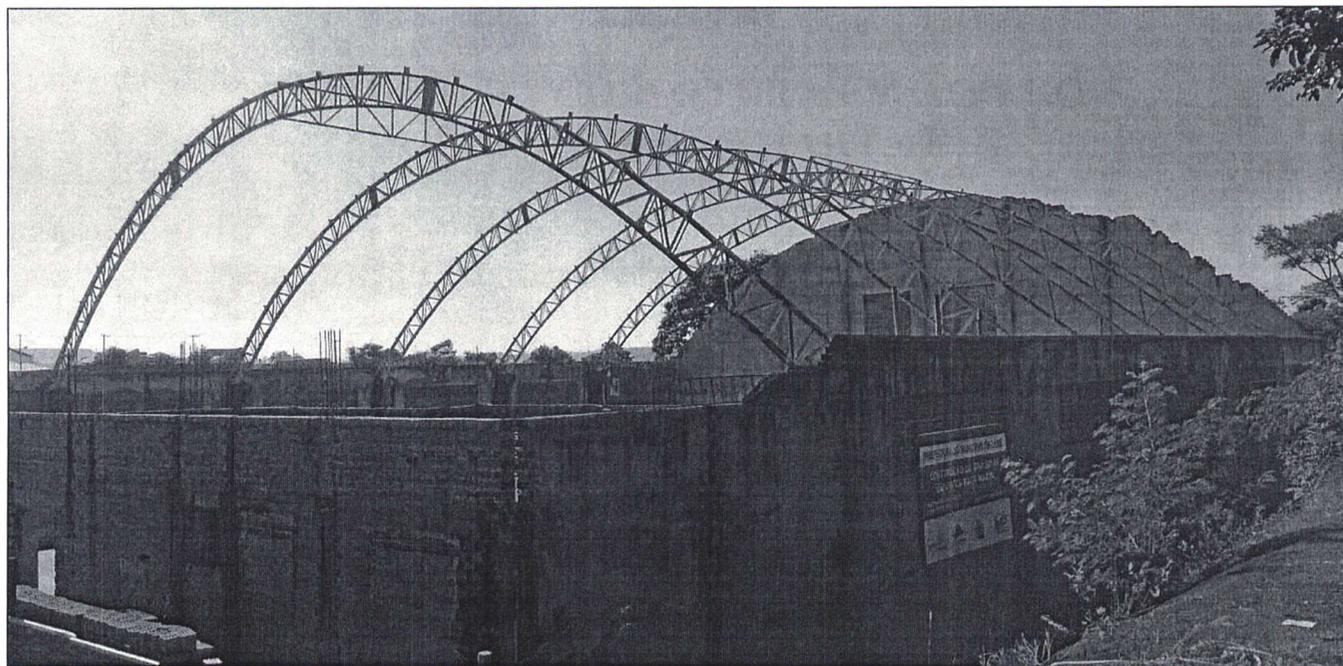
Estado atual da estrutura do Ginásio Santa Marta II em Leme.
